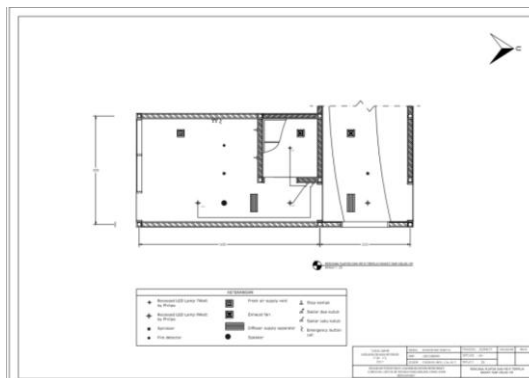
Rencana lantai ruang terpilih kamar rawat inap kelas VIP
